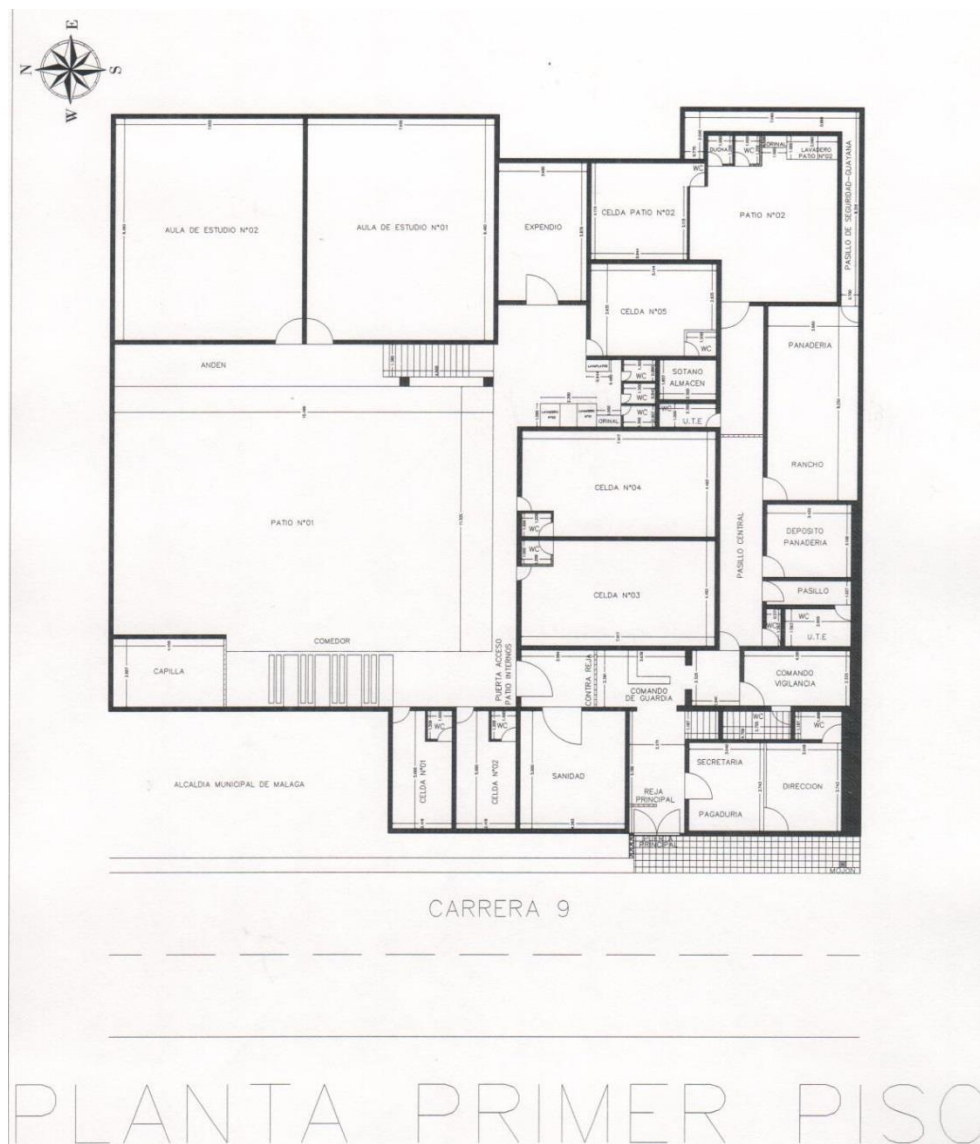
Plano arquitectónico primer piso. Adaptado Plan de emergencia y contingencia 2017 EPMSC Málaga.
